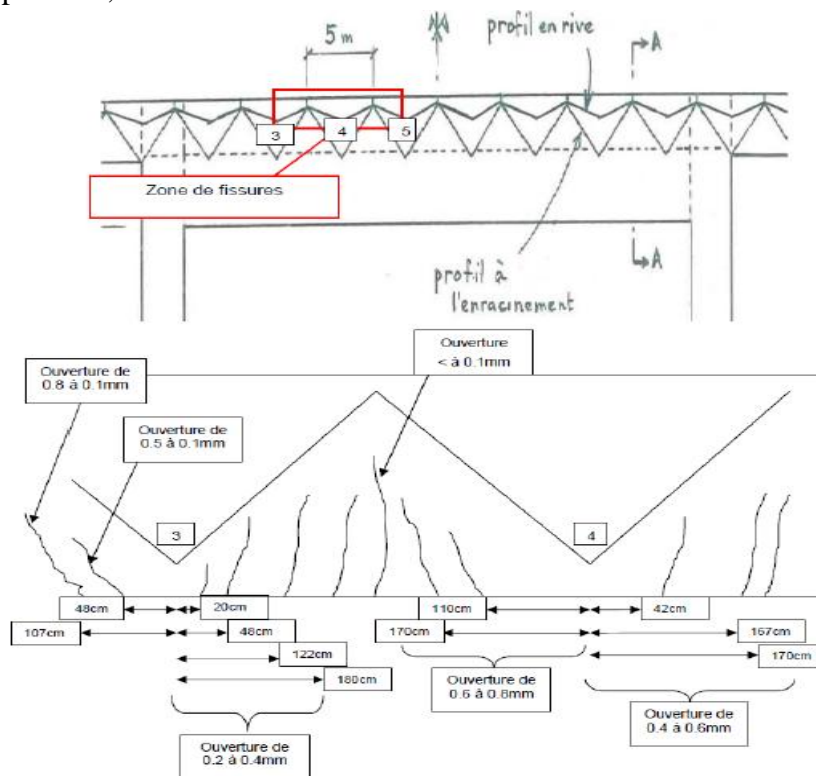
Schéma des fissures constatées dans la poutre de rive.
